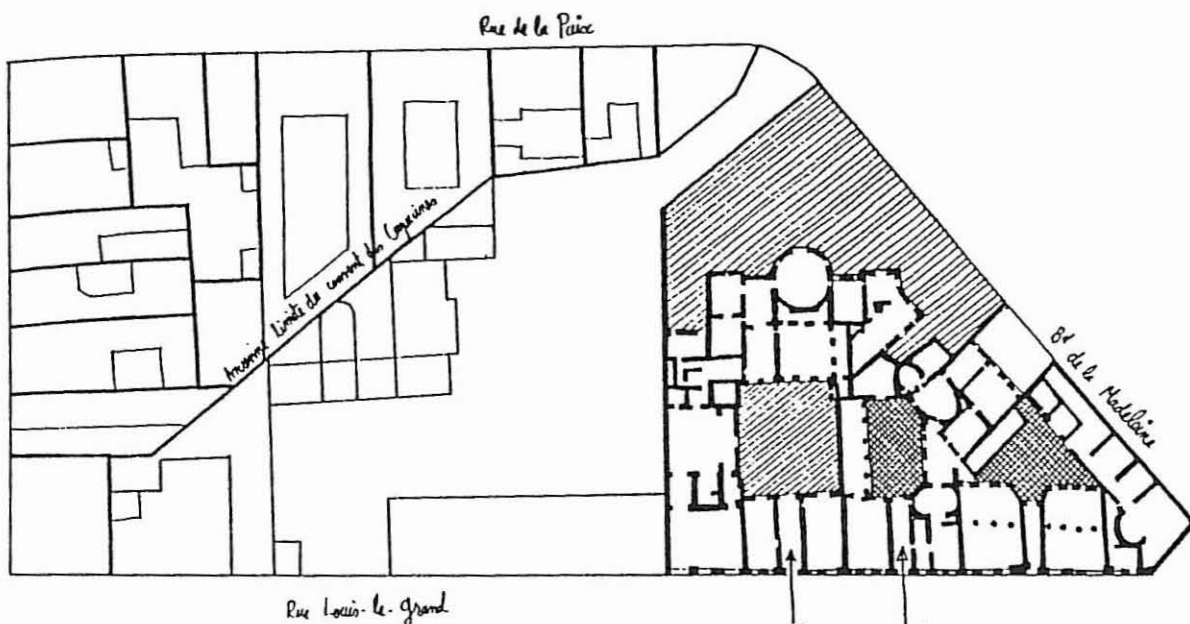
(CVI) Hôtel de Gonteau, rue Louis-le-Grand. Moreau. 1772. Plan du rez-de-chaussée.
